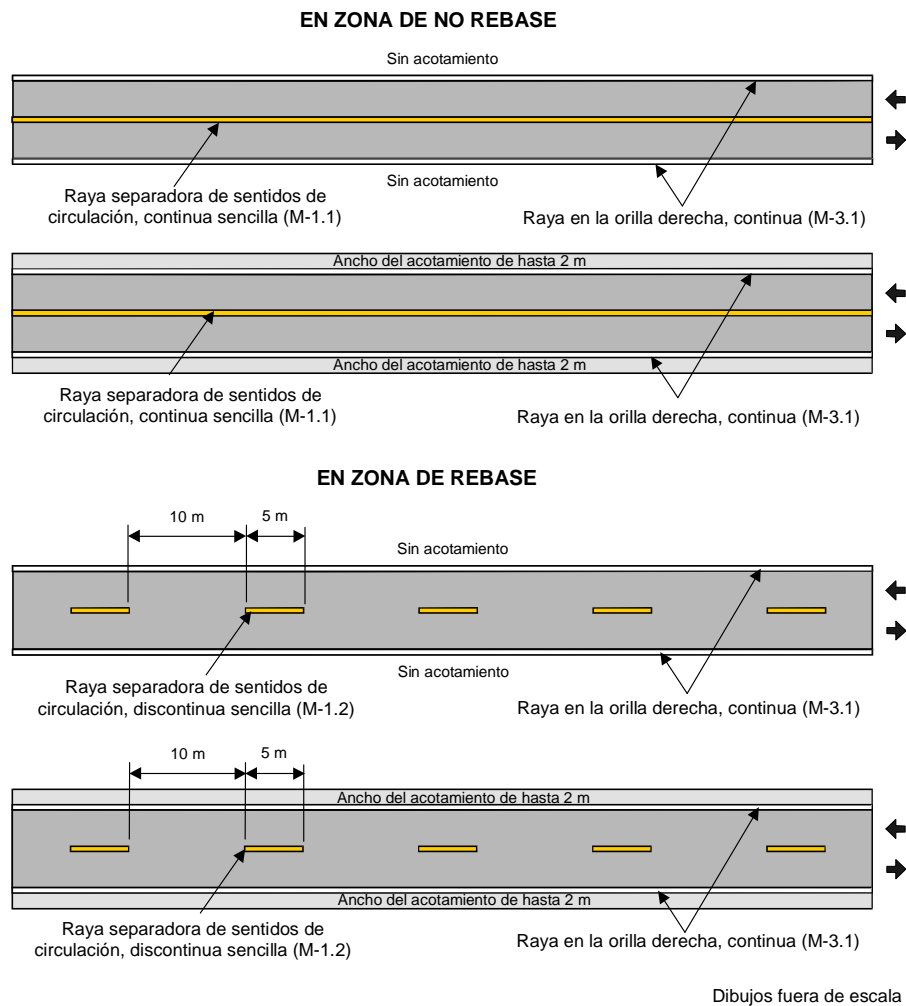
Marcas en el pavimento en carreteras con ancho de arroyo vial de hasta 6,5 m
